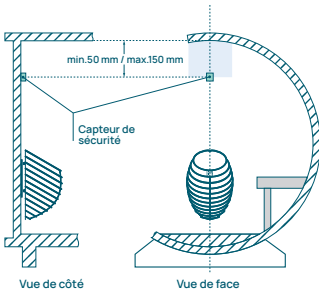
Installation du capteur de sécurité sur le mur dans les saunas tonneau : chauffage mural
